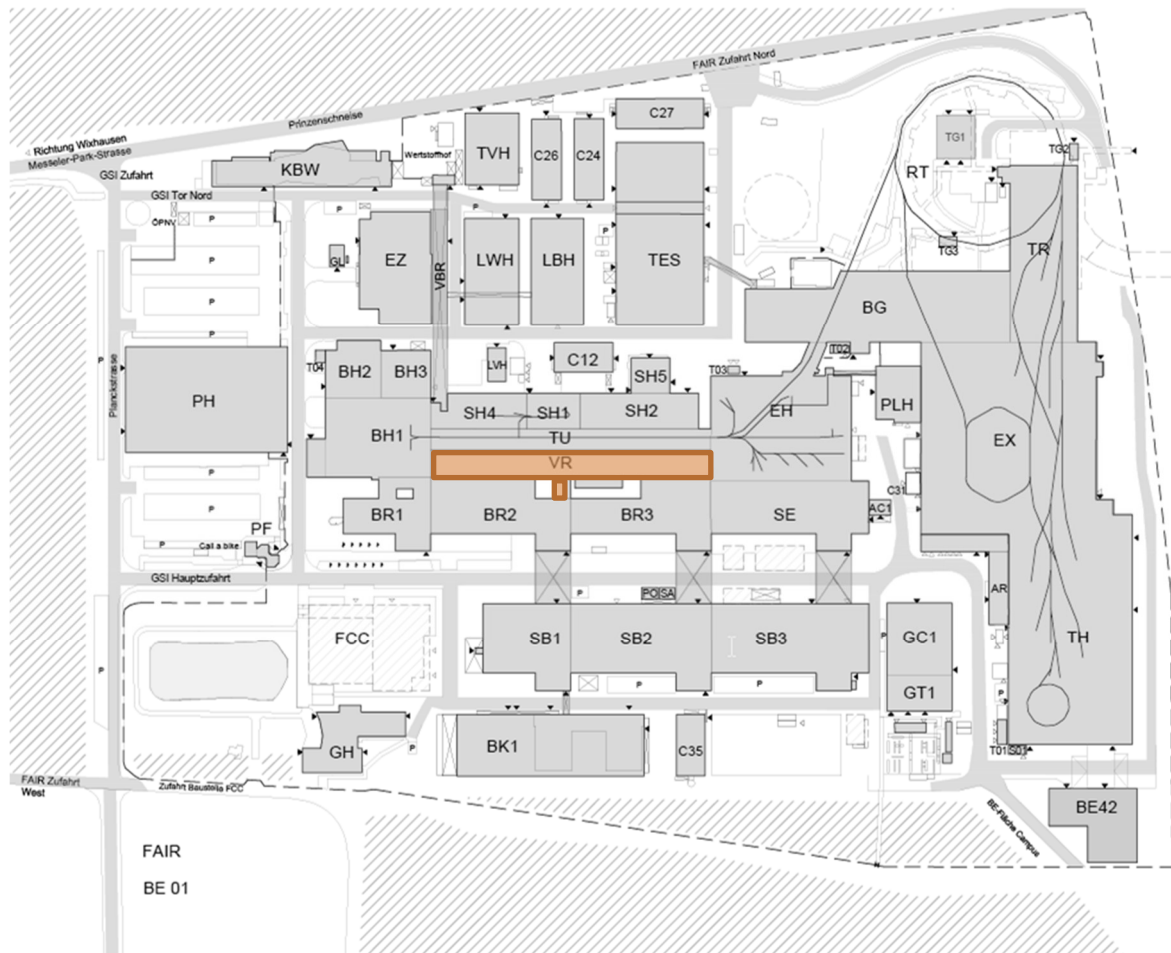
Lageplan der GSI mit Markierung des zu beplanenden Gebäudeteils
